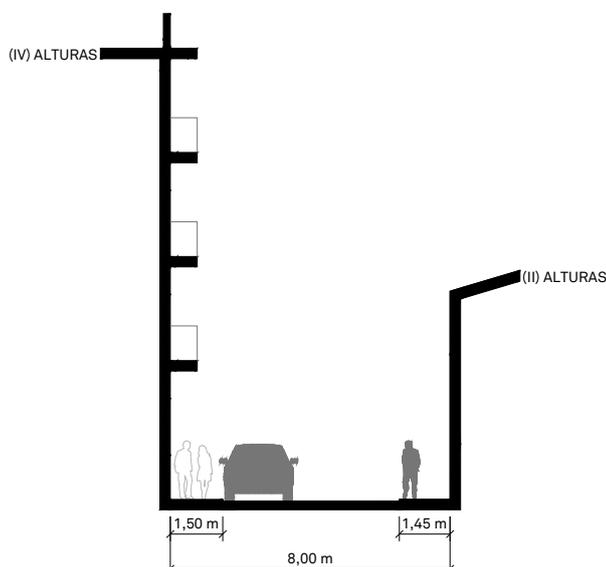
y 128. Calle Villar del Arzobispo. Elaboración propia.
